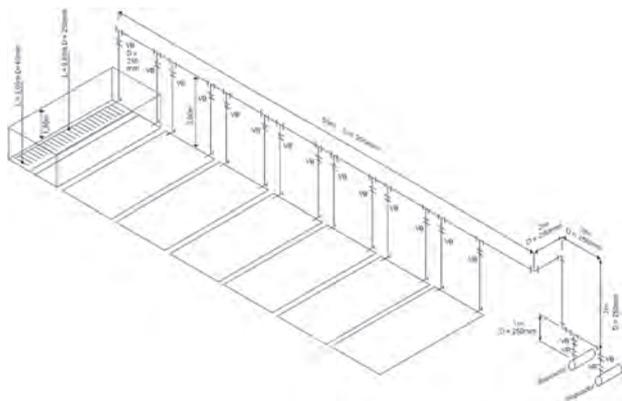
Sistema de lavagem auxiliar com ar: perspectiva isométrica.
